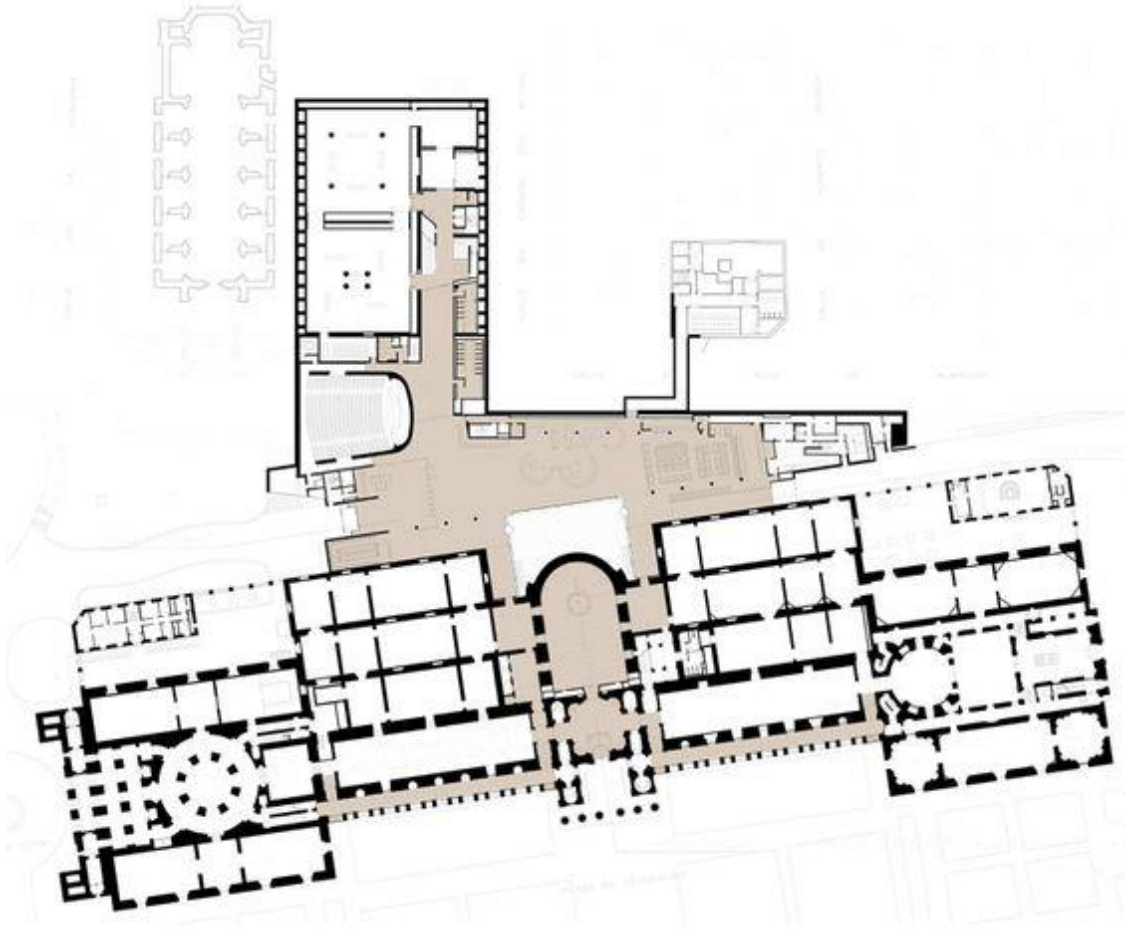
Plano planta baja tras el proyecto de ampliación y reforma de Rafael Moneo
